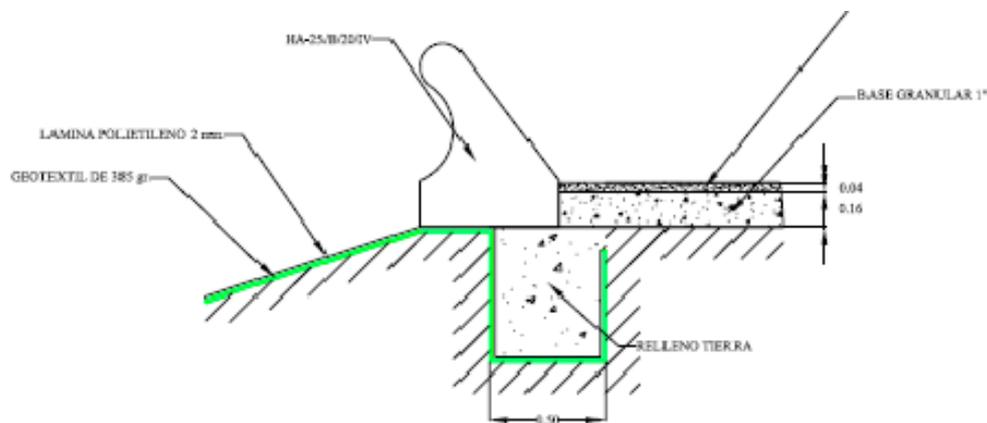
Detalle de anclaje en coronación de la lámina y geotextil.
